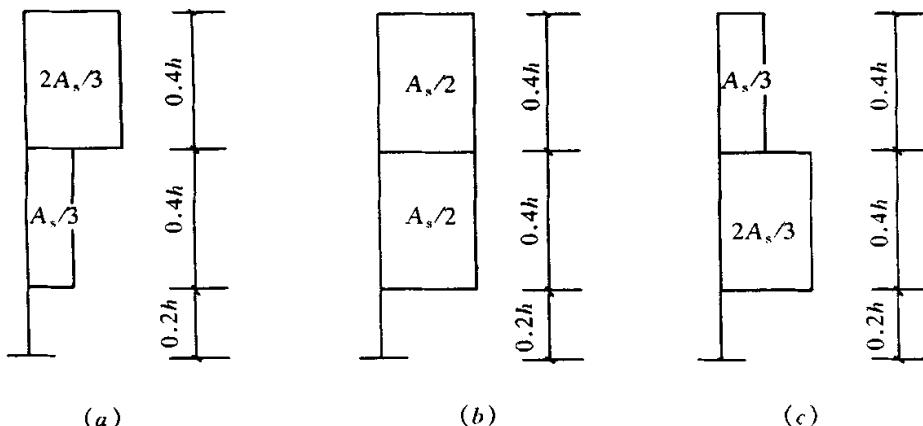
连续深梁中间支座截面纵向受拉钢筋在不同高度范围内的分配比例
